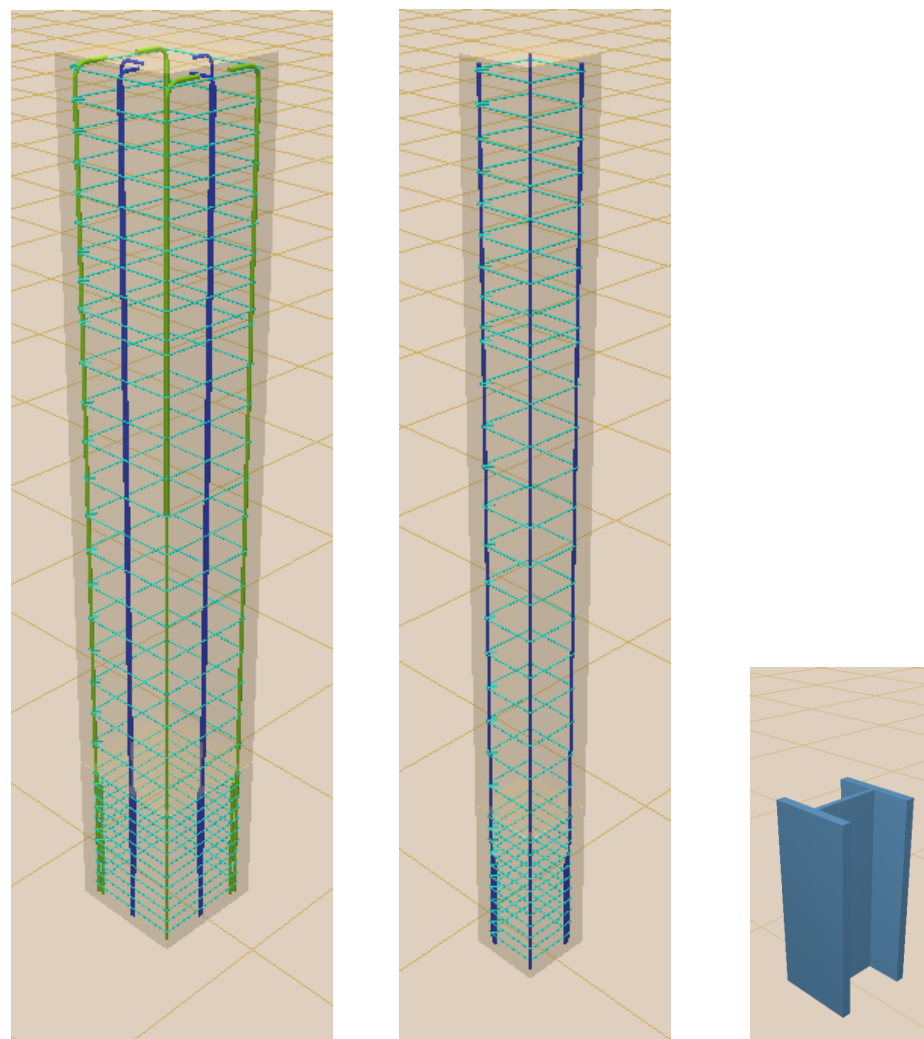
Detalle 3D de las agrupaciones 1, 2 y 5. Fuente: Propia
